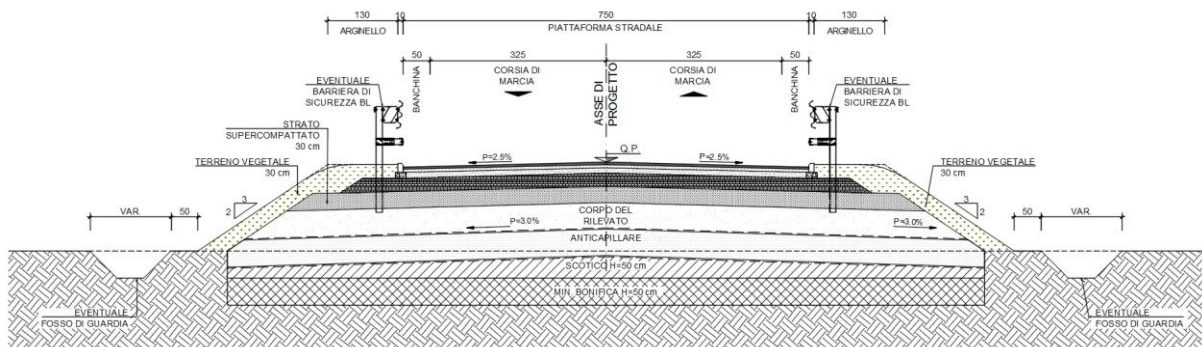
Sezione tipo in rilevato Strada F – Locale in Ambito Urbano
